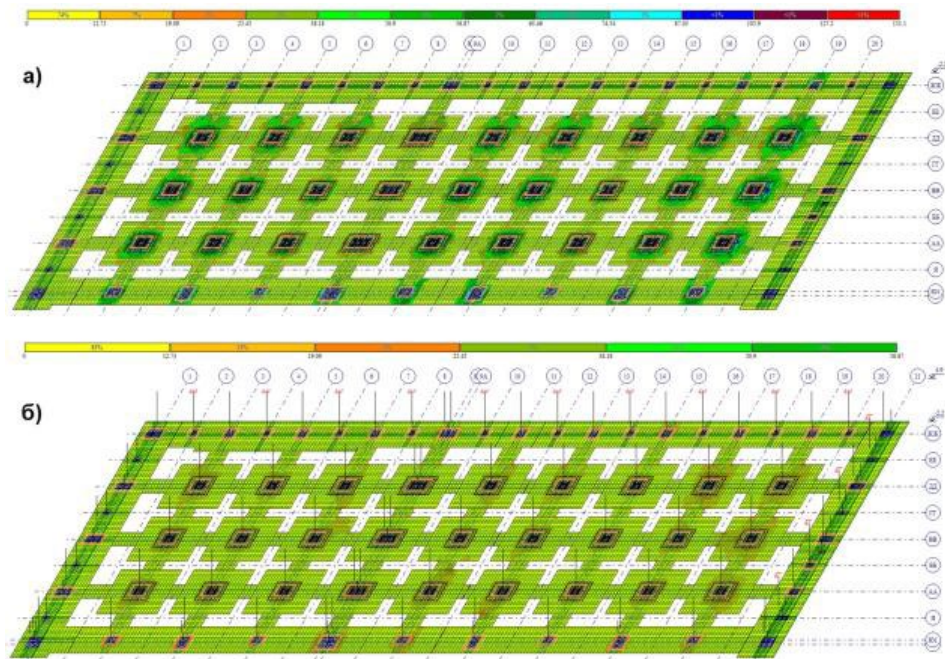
Армирование фундаментов (нижнее вдоль буквенных осей) антресольной части здания склада от действия РСН (а) и ОСН (б)
